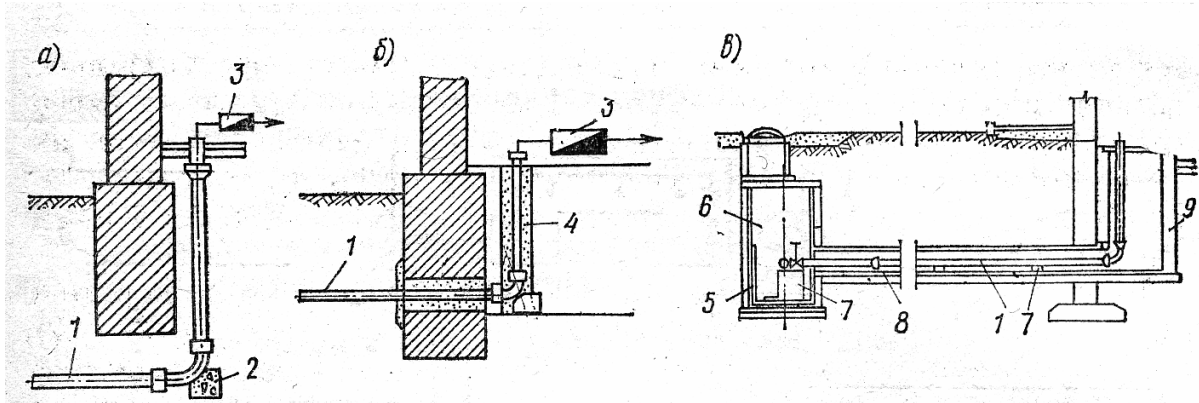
Схемы прокладки ввода ниже фундамента(а), через фундамент здания(б), в просадочных грунтах(в).
